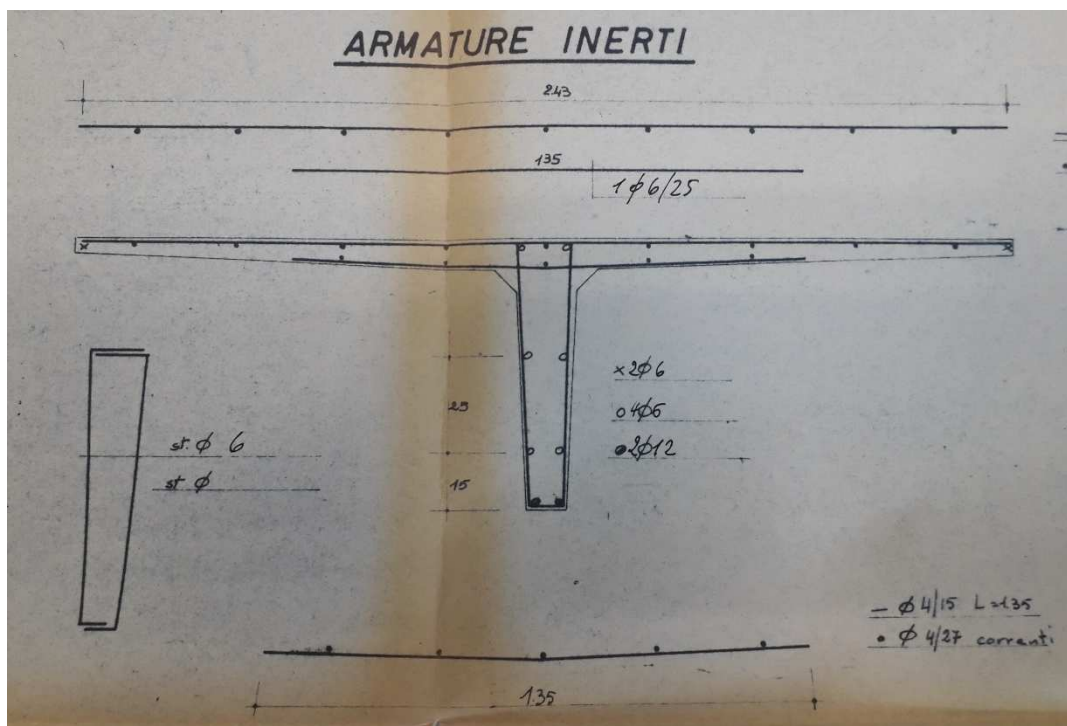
Foto della sezione della trave prefabbricata di copertura con l'armatura lenta.
